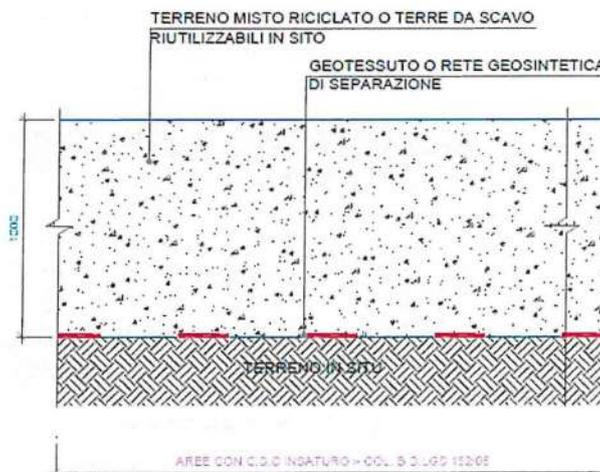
pacchetto in aree esterne alla pavimentazione portuale
